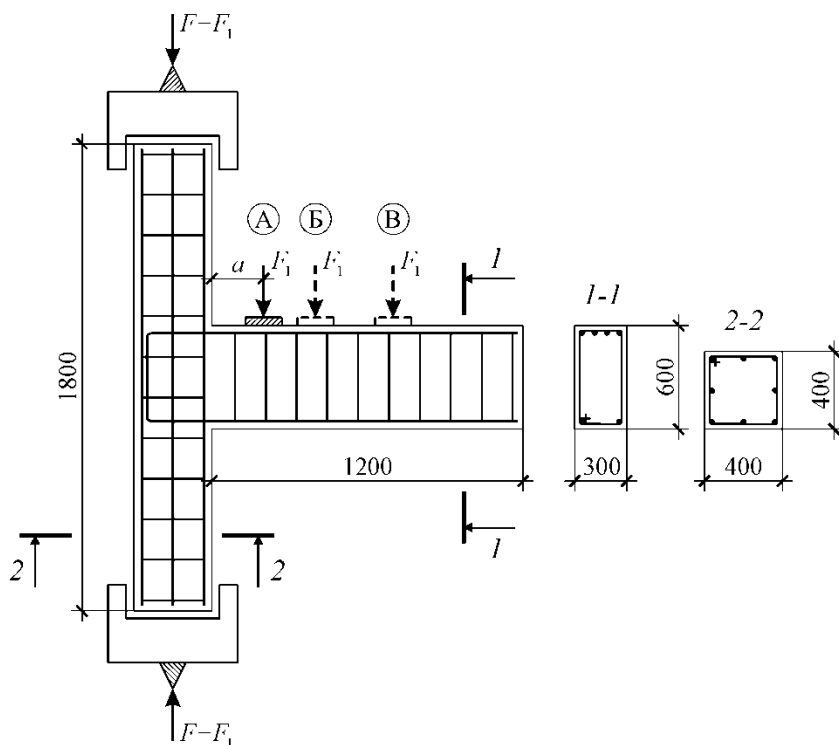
Схема испытания монолитных узлов сопряжения железобетонных каркасов зданий (Пензенский ИСИ, 1984 г.)
